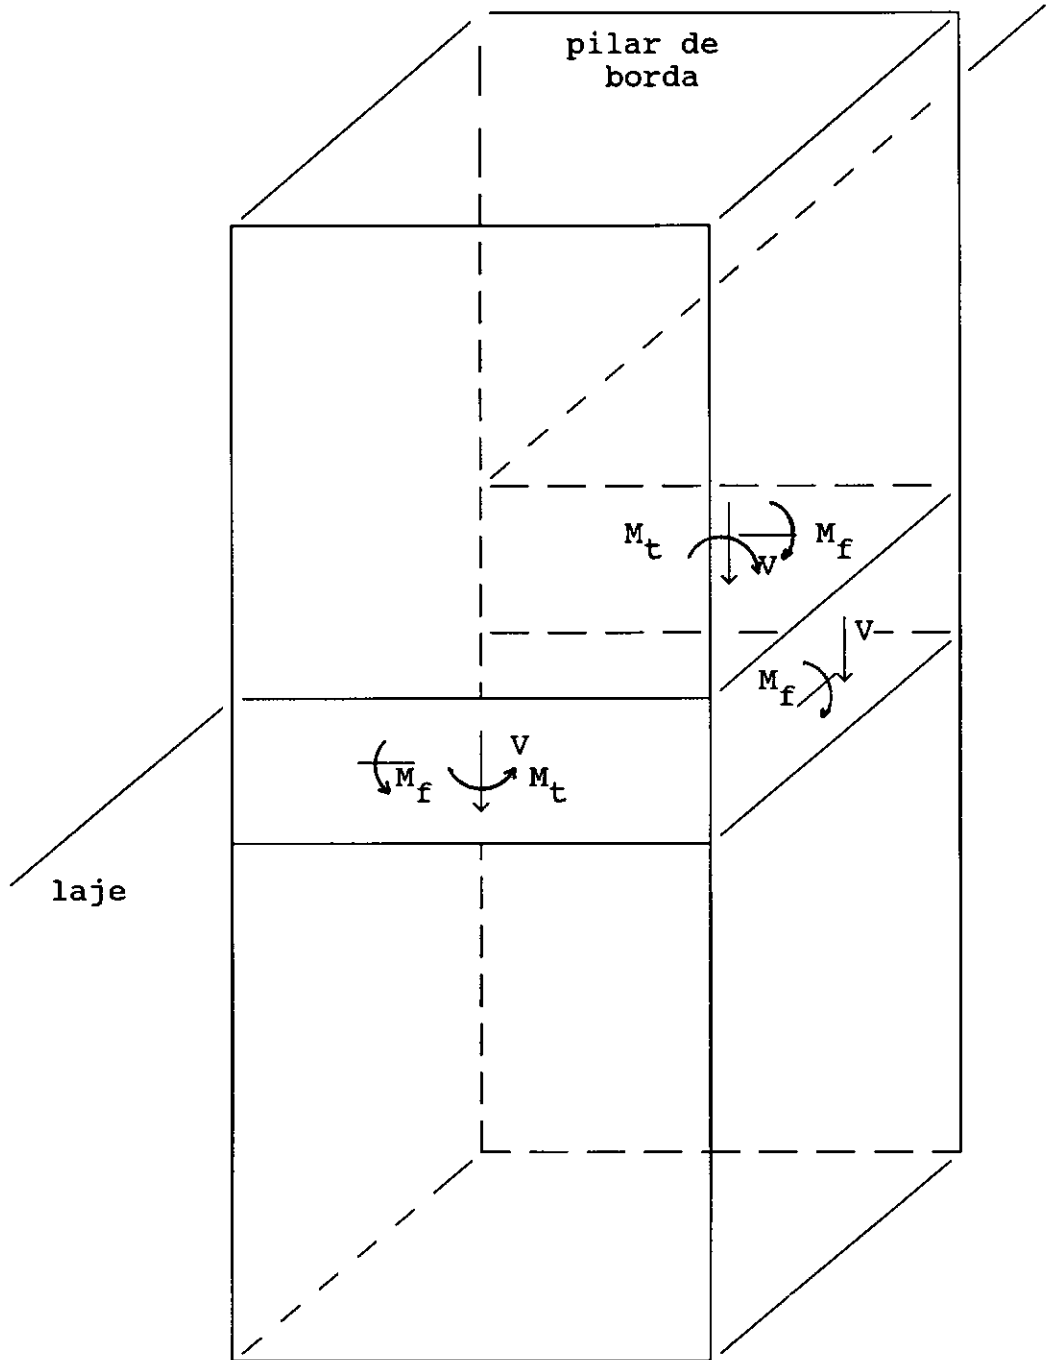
Tipos de esforços na ligação laje-pilar
